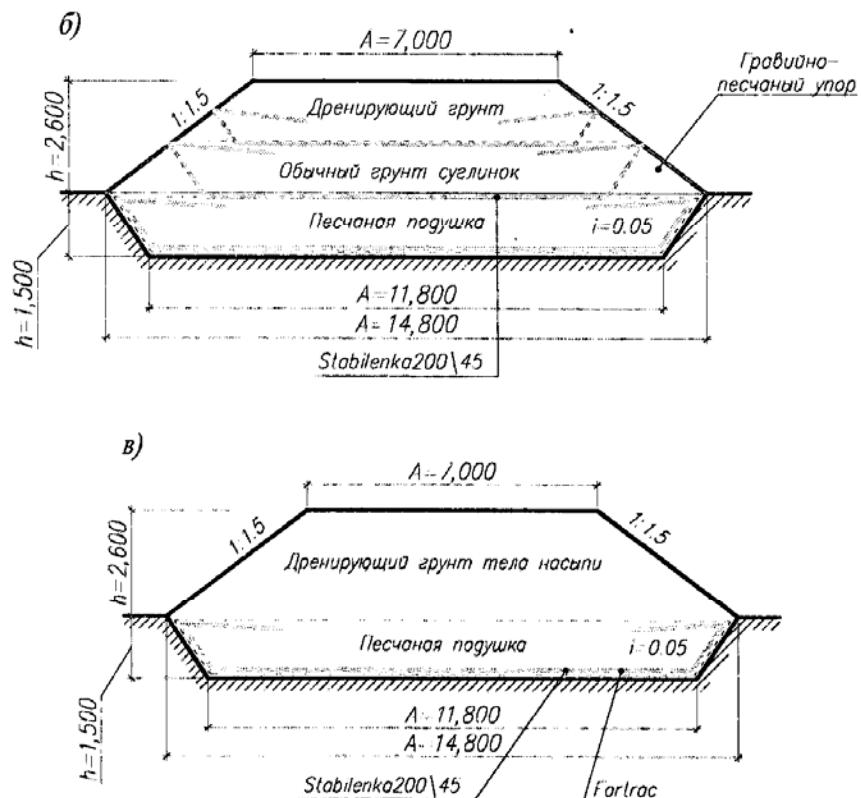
Конструкции армированной геотекстилем насыпи земляного полотна:
